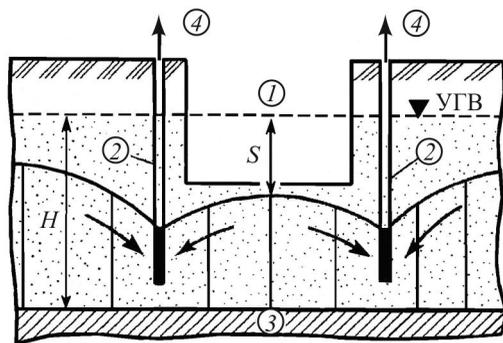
Осушение строительного котлована иглофильтрами: 1 – строительный котлован; 2 – иглофильтры; 3 – водоупорный грунт; 4 – откачка грунтовой воды; S – величина понижения уровня грунтовой воды; H – уровень статического горизонта грунтовой воды
